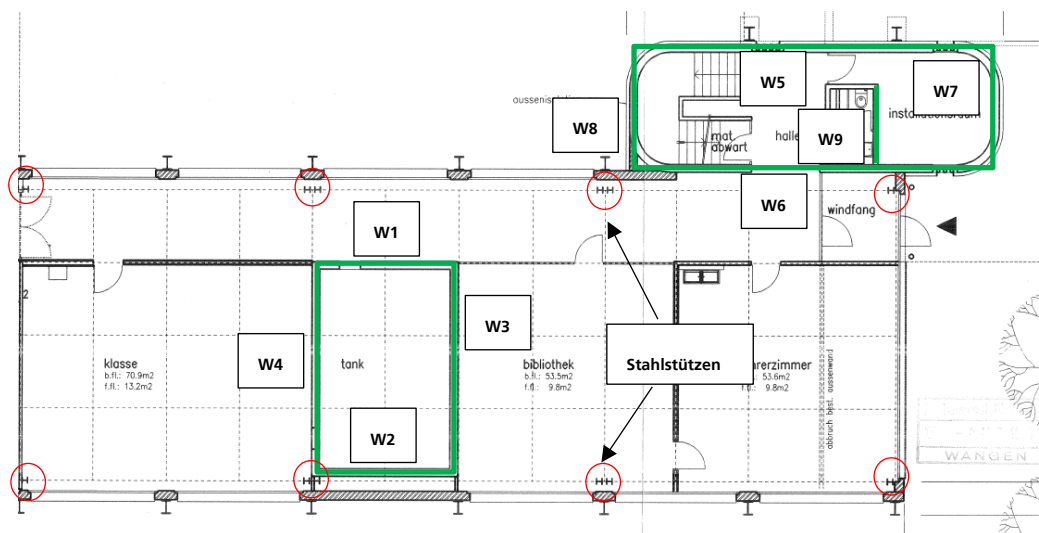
Aussteifungssystem Erdgeschoss Etappe 1 (Zustand Jahr 1972)
